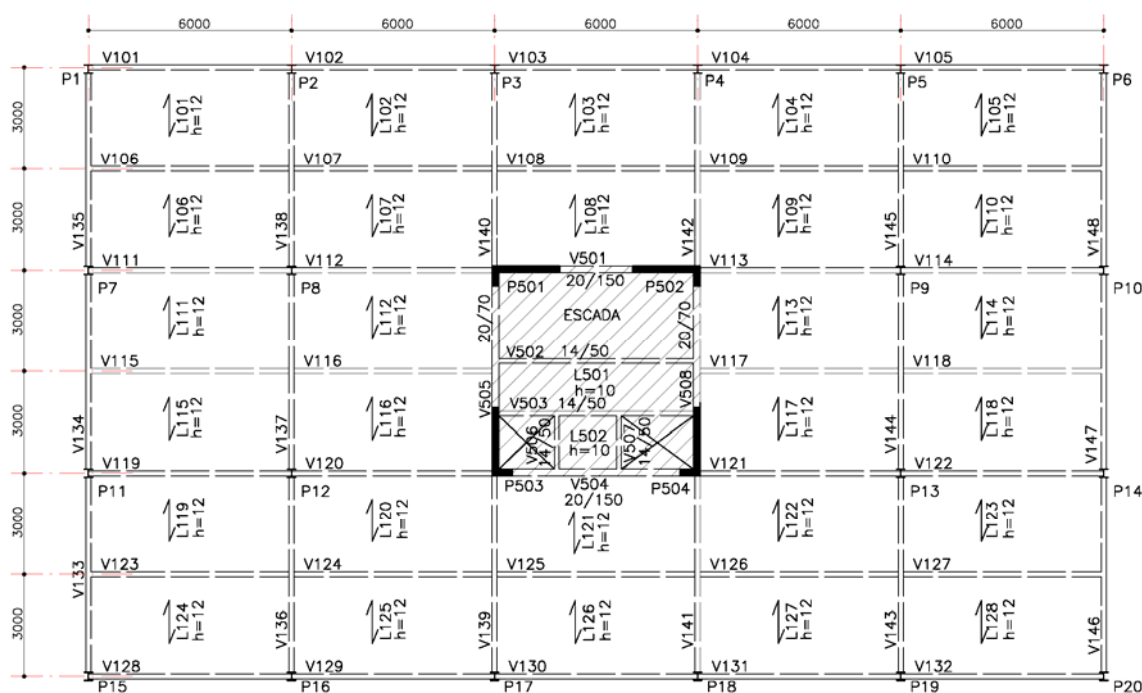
Plano de vigas – laje pré-moldada com trilhos protendidos
